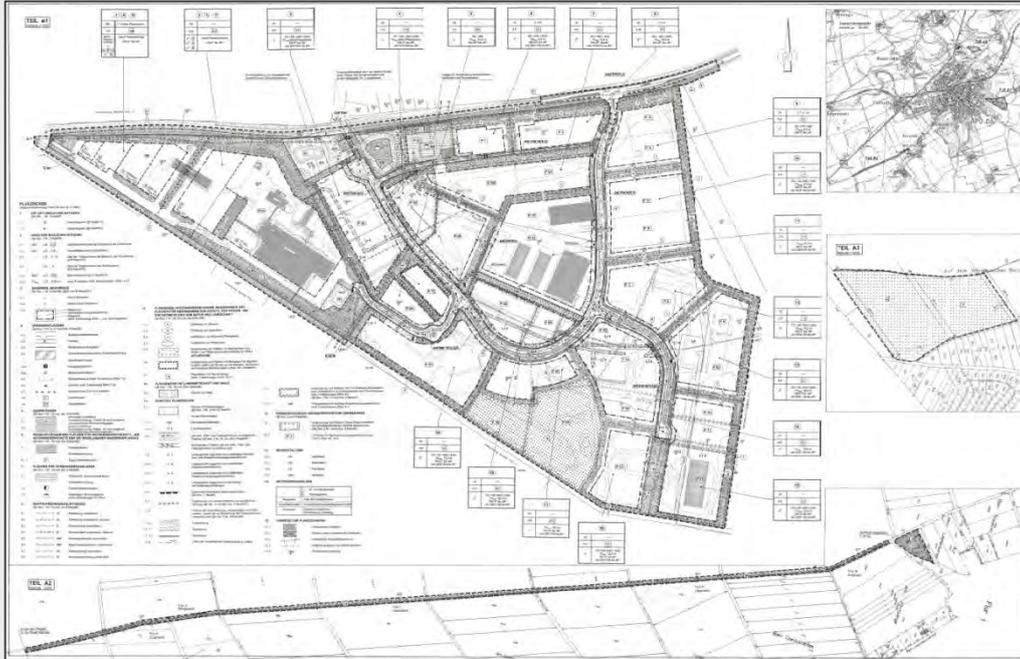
geänderte Anlage zum B-Plan „Nr.14 – Industriegebiet Laborchemie“, Altlasten
